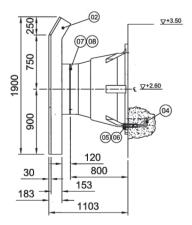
Defensas Efectivamente Instaladas no Muro da Zona 3A (Tipo Hipercélula)
